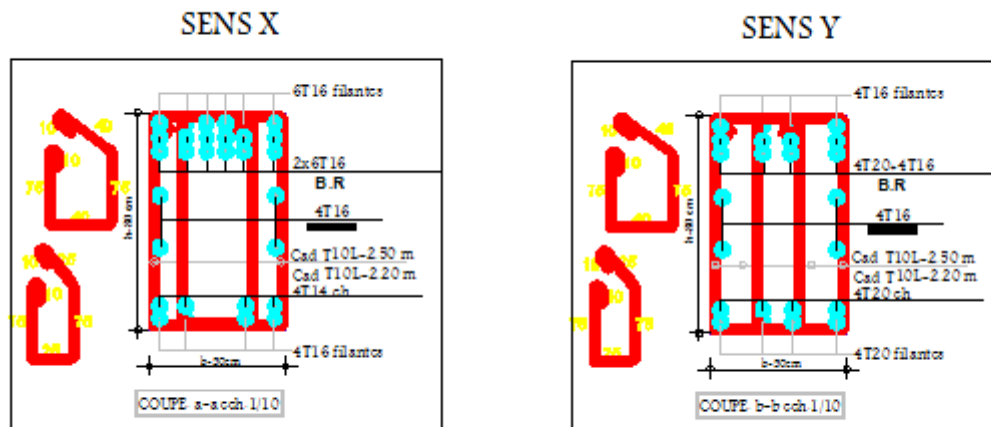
Schéma ferrailage la poutre de libage.
